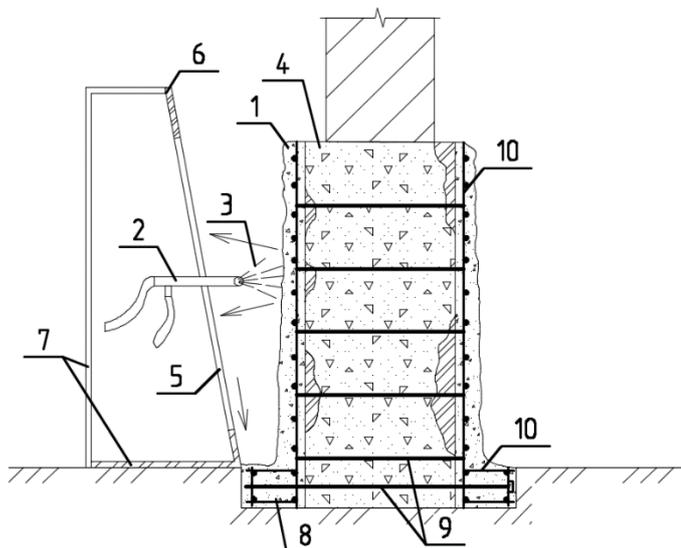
Процесс нанесения набрызгбетона на стены фундамента
